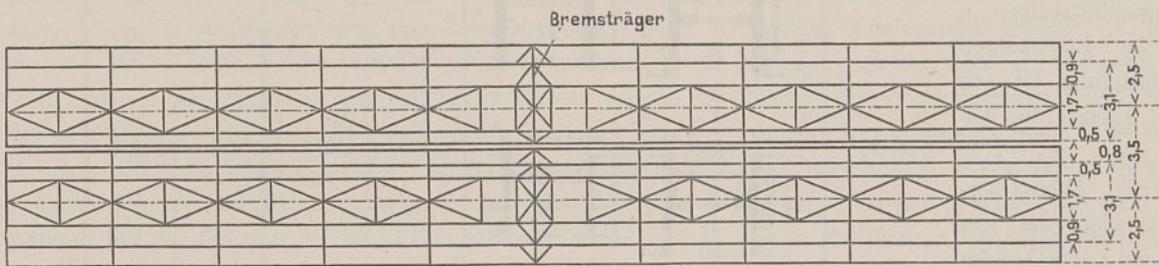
Grundriß der Fahrbahn beider Überbauten.
